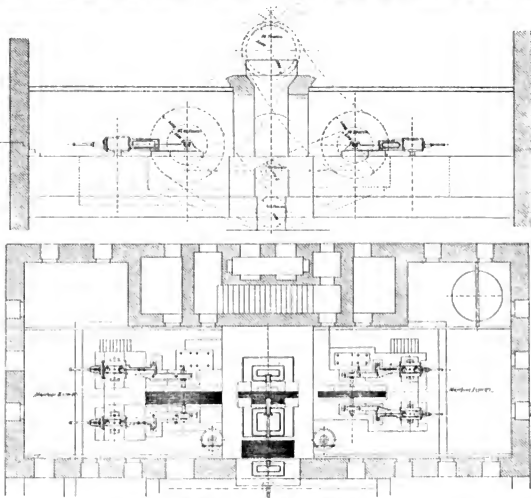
Aufriss und Grundriss des Maschinenhofes.
